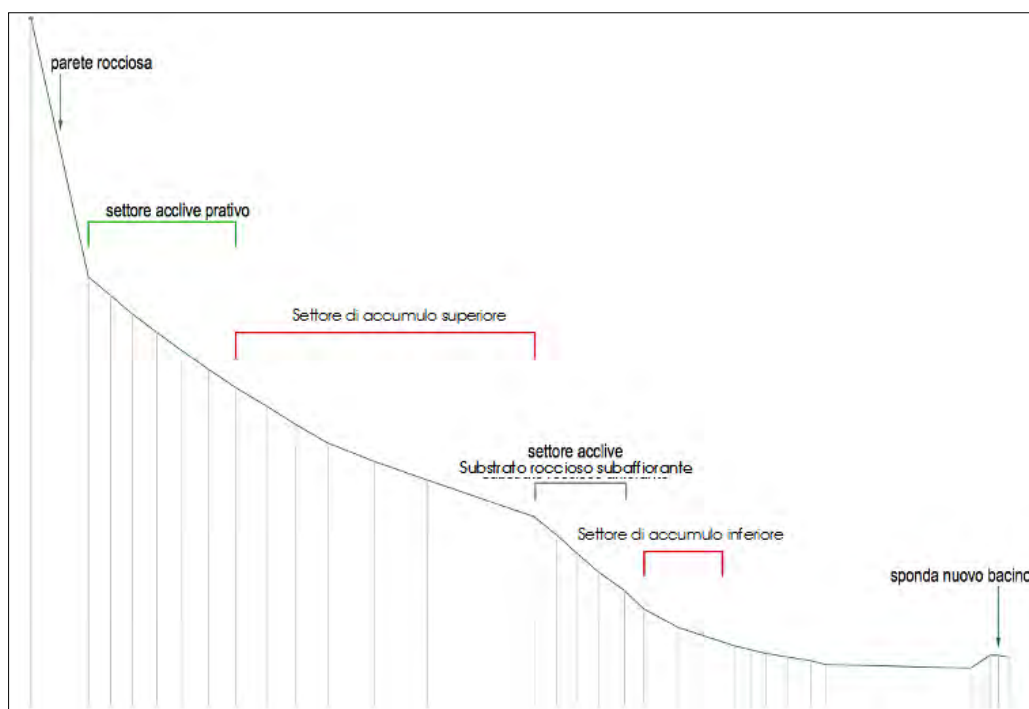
Schema del versante a monte dell'area di progetto del nuovo bacino
